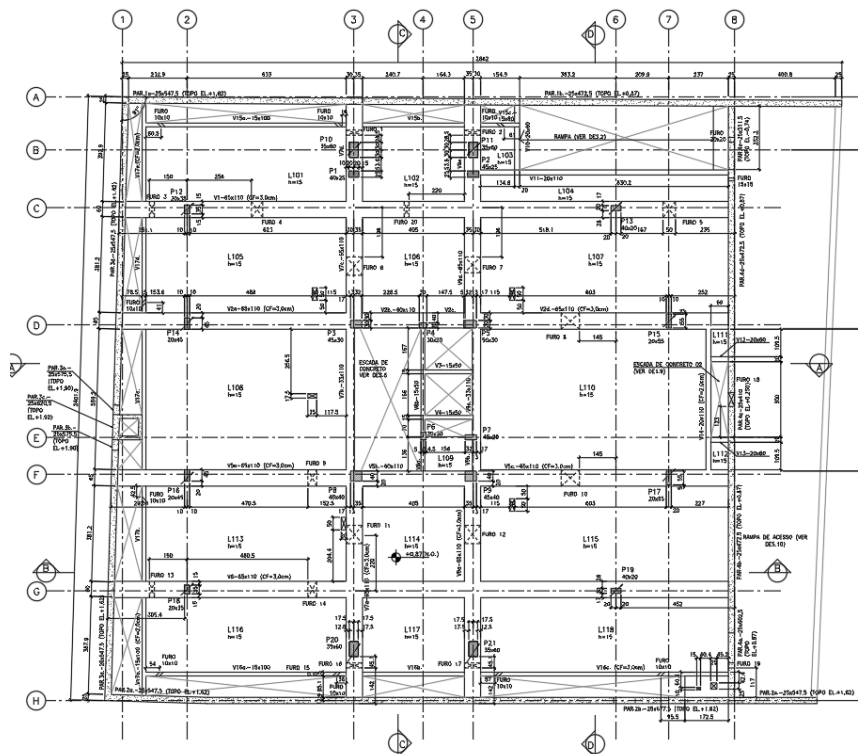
Planta do teto do térreo - pavimento de transição [desenho código 03-DPSC-PE-EST-PB-03-R01].
